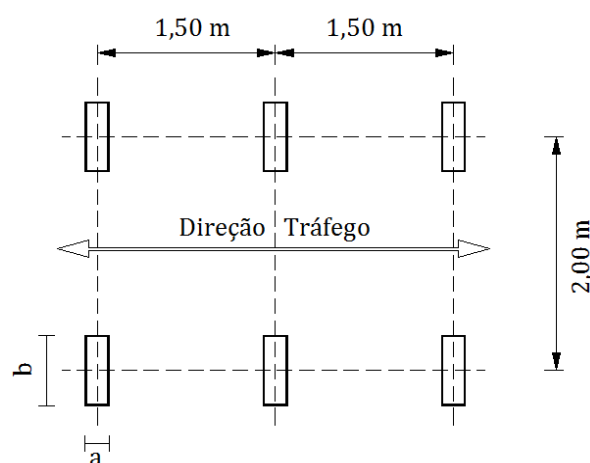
Configuração em planta do veículo tipo do RSA
